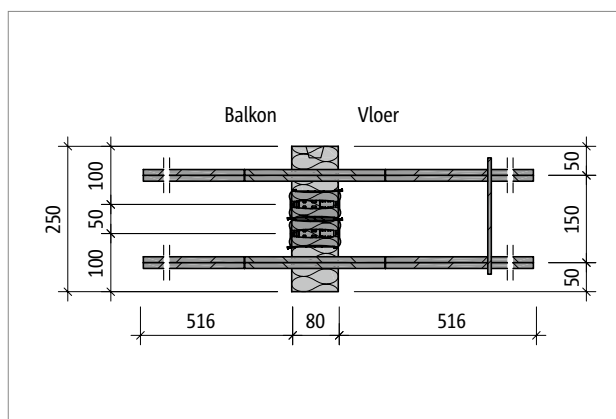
Schöck Isokorf® T type Q-E-V5-L500 bij R0: Bovenaanzicht
